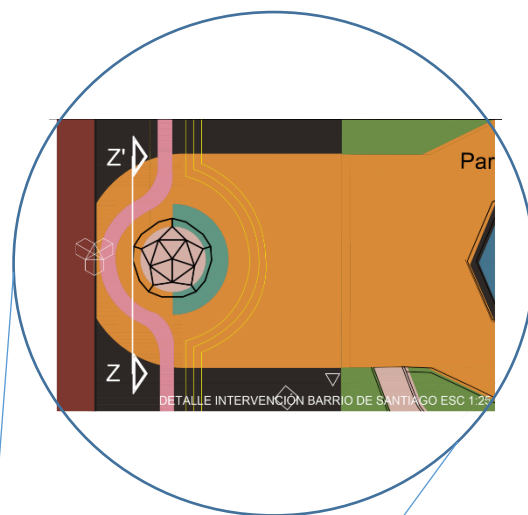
Vista en planta Fuente: Elaboración propia.
